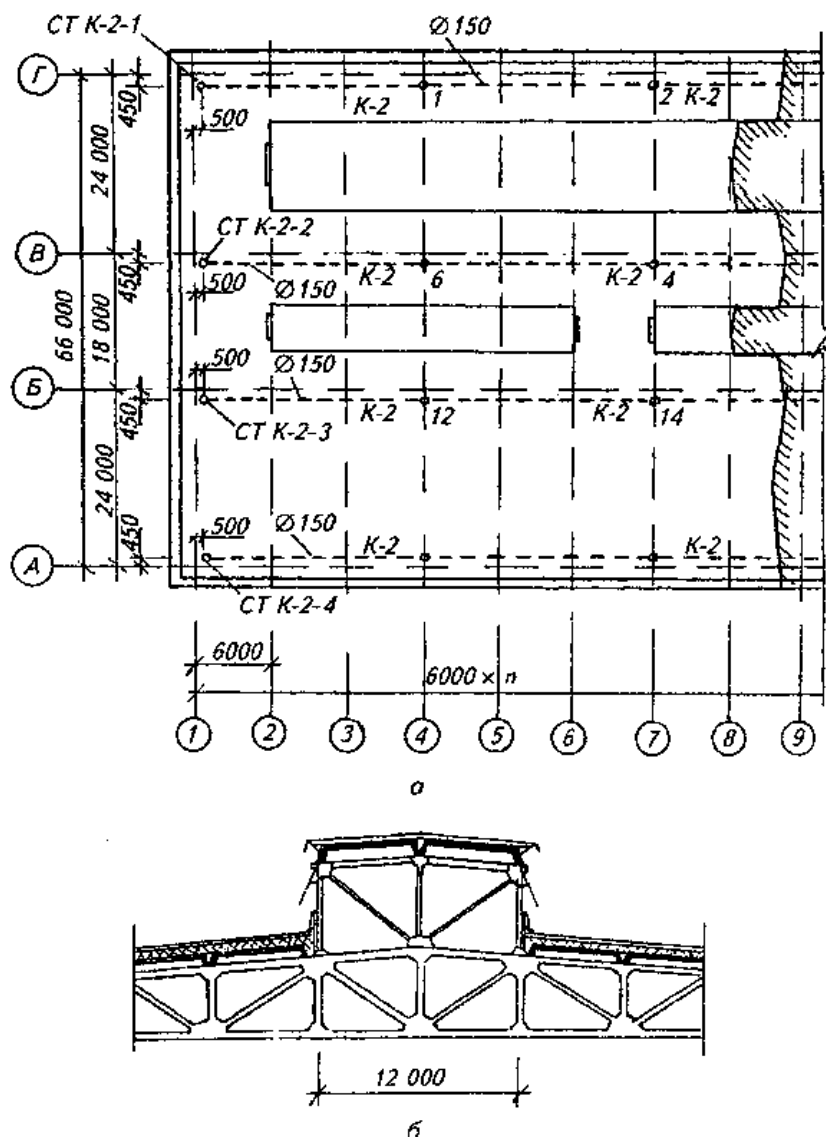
Схемы расположения (а) и конструкция светоаэрационных фонарей (б)
